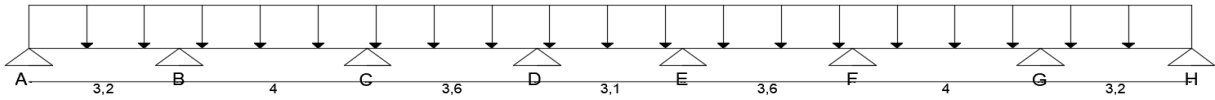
Schéma statique d'une poutre reposant sur 8 appuis à l'ELU
